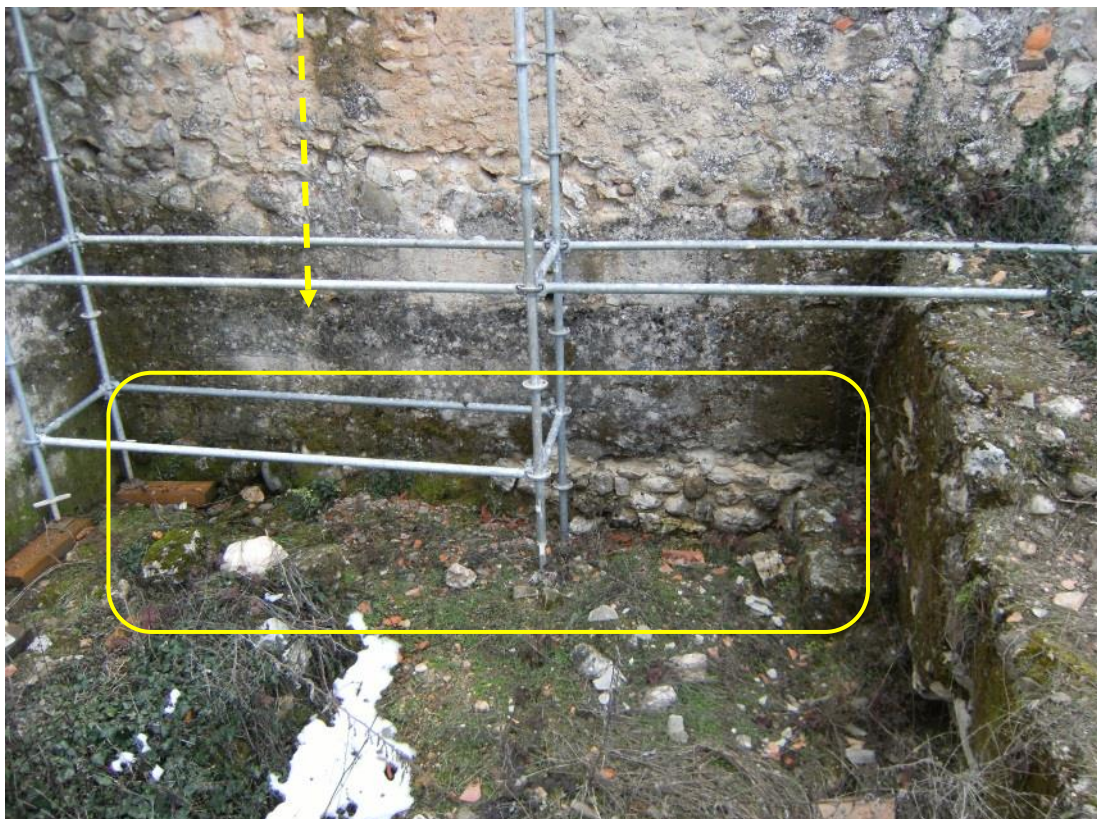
Lugar (detalle) en el que se localizó la columna. Marzo 2.015.
